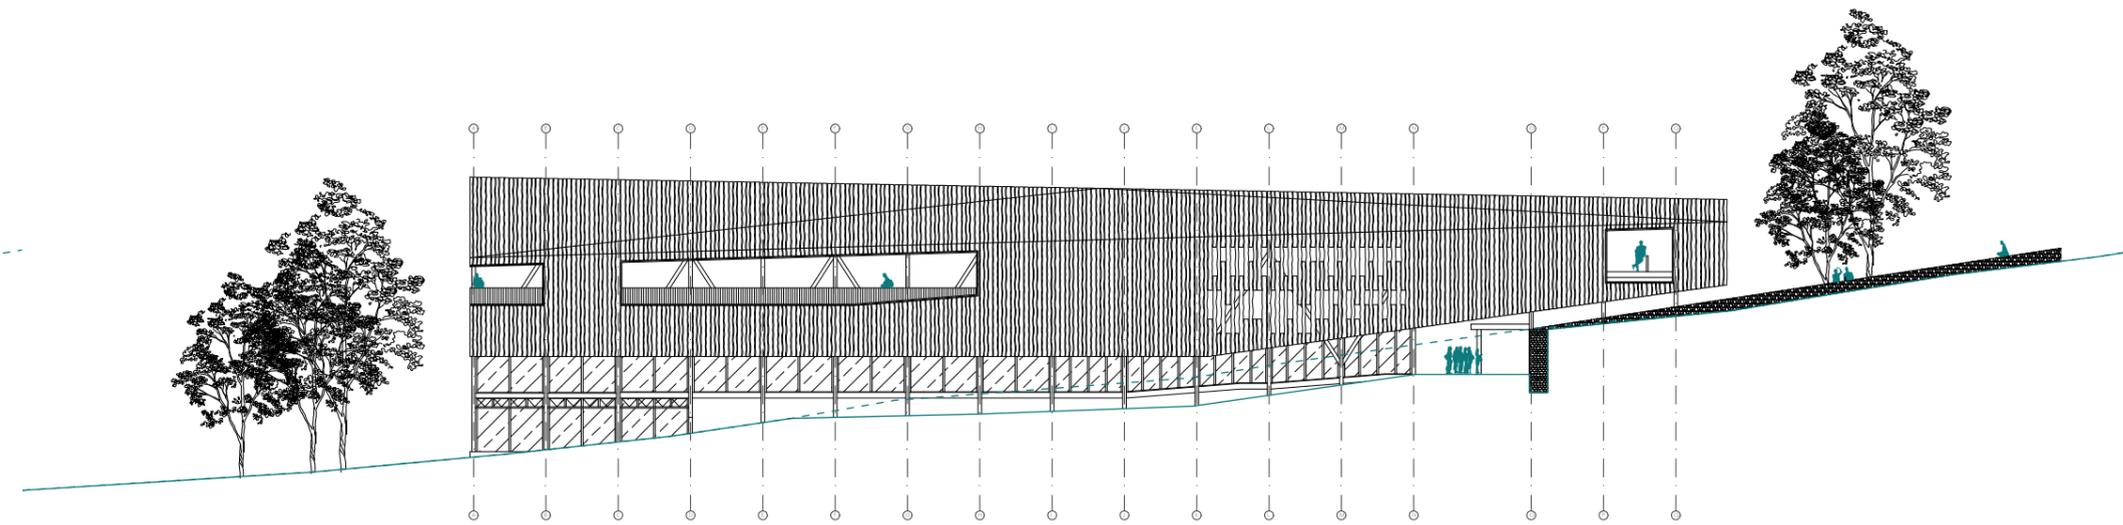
Planimetría desarrollada hasta la fecha del proyecto. Elaboración propia.
